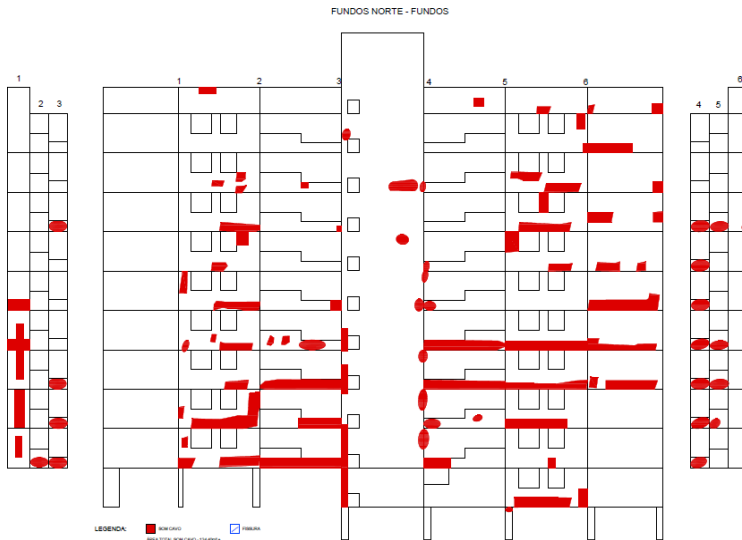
Prancha com a identificação dos descolamentos da Fachada do Fundos.
